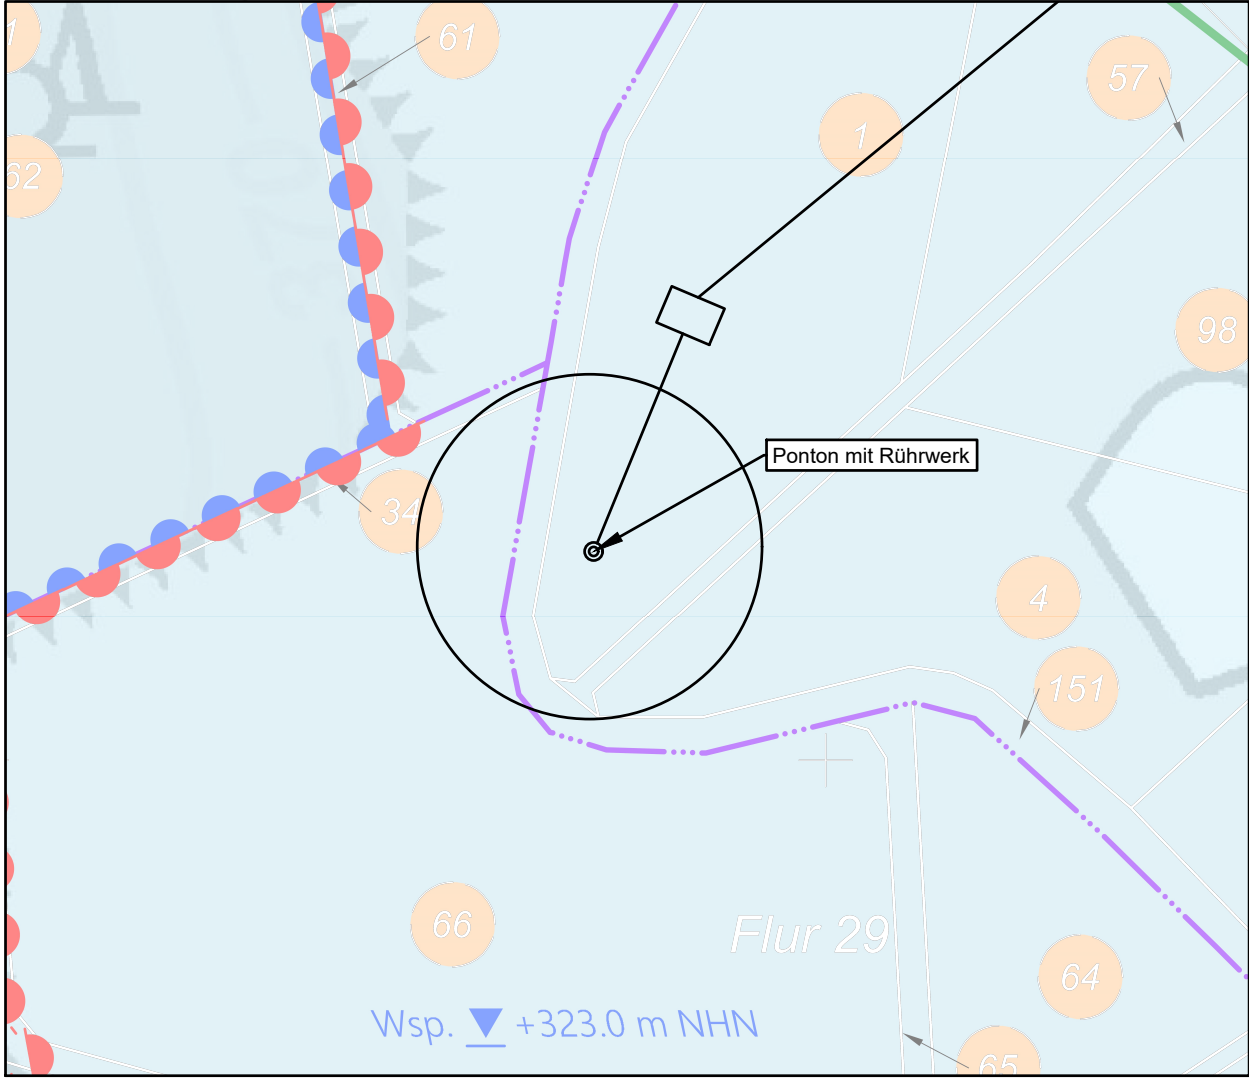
Ponton und Seewasserleitung Oberfläche M 1:25
